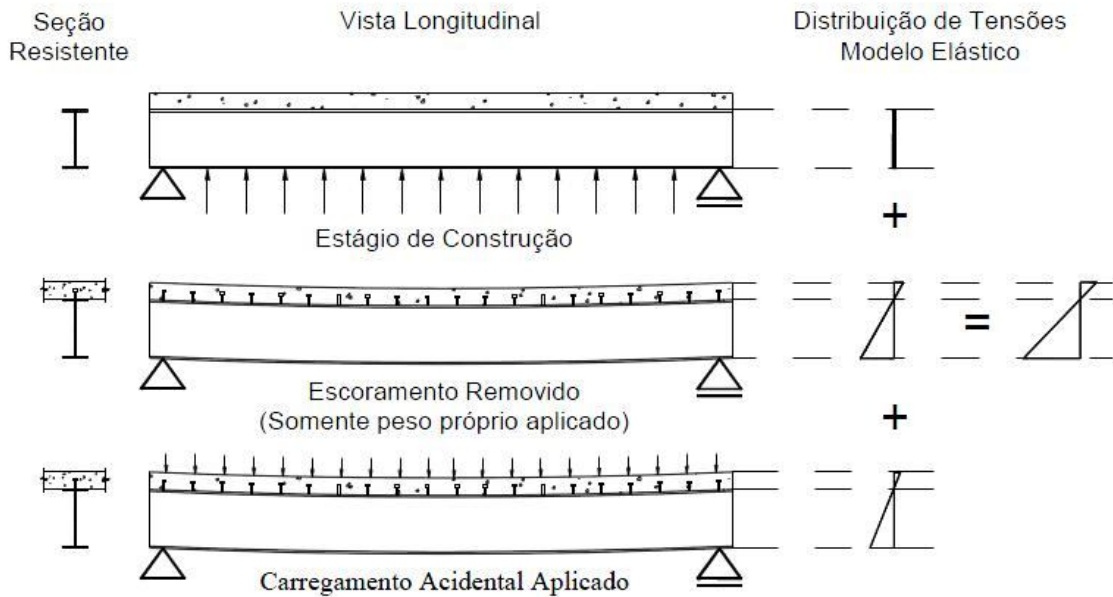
Vigas mistas escoradas (FABRIZZI, 2007)
